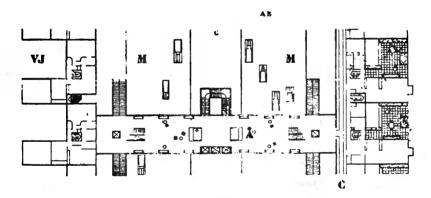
Planta a la altura del vestíbulo de entrada en pasarela sobre la calle. A izquierda y derecha, los inmuebles, separados por la calle de 50 metros de ancho; luego, las veredas con las escaleras de acceso al vestíbulo; en seguida, las dos calzadas en una sola dirección; en el medio, el techo de los garajes.
